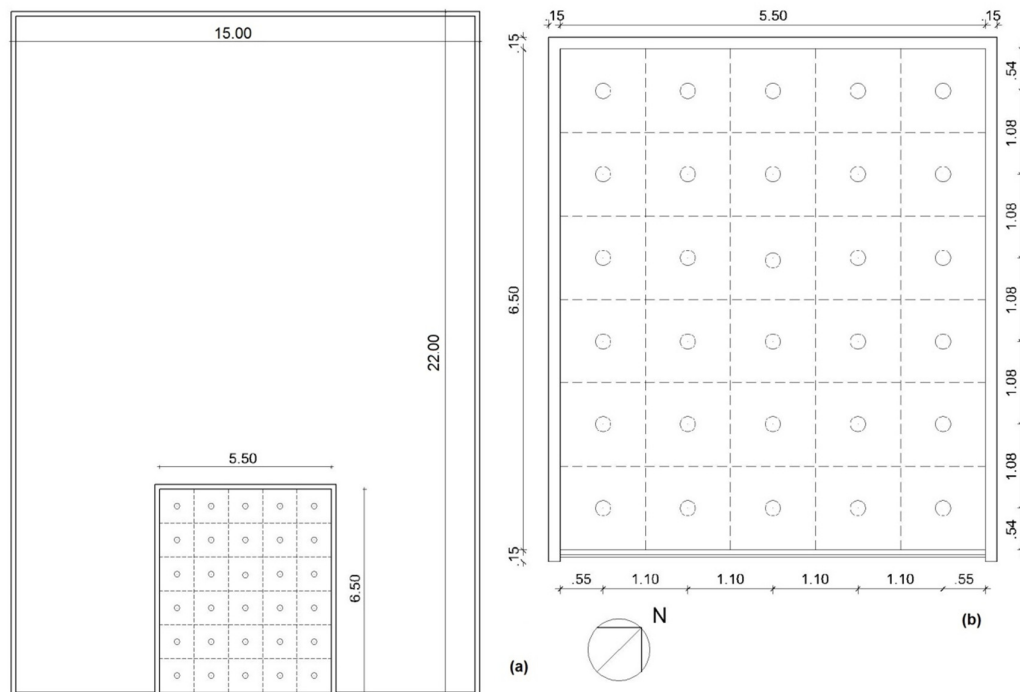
Planta baixa do edifício (a) e planta baixa do ambiente estudado (b).
